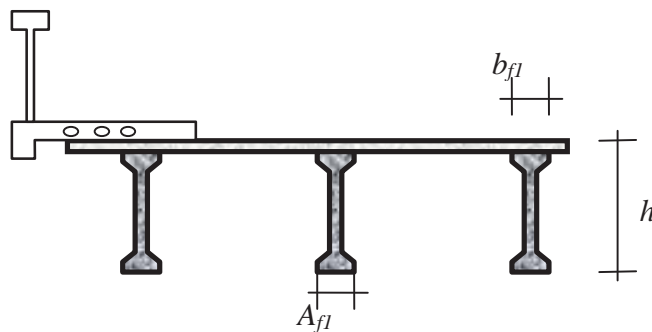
Esquema de la sección transversal tipo en losas sobre vigas de sección I
